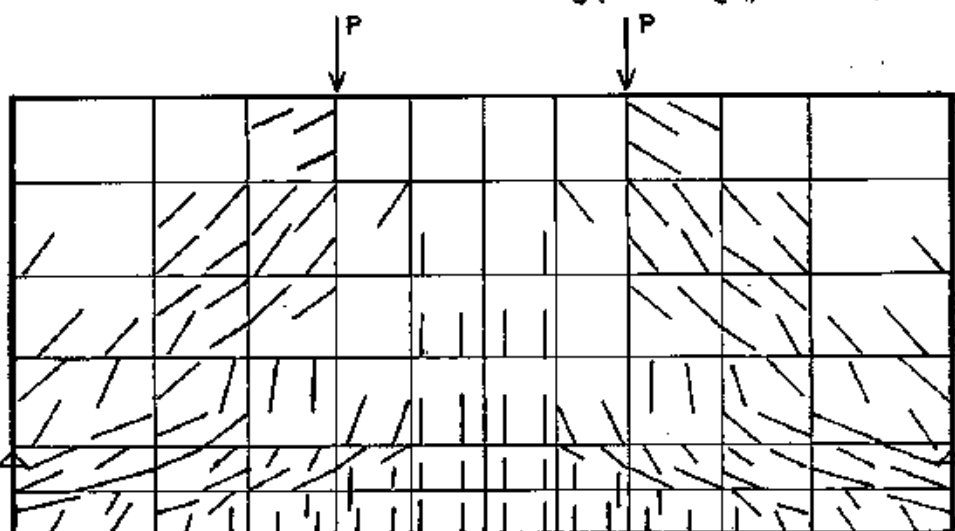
Configuração das fissuras (modelo)
